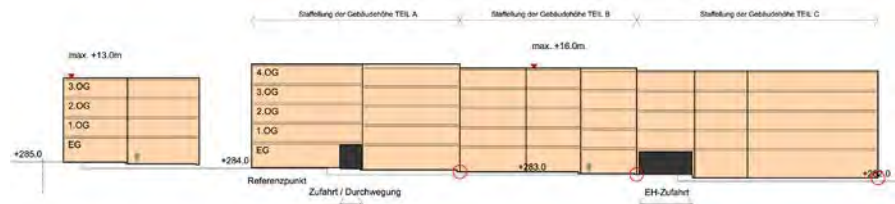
Prinzip der Gebäudestaffelung entlang der Hauptstrasse je Baustappe
